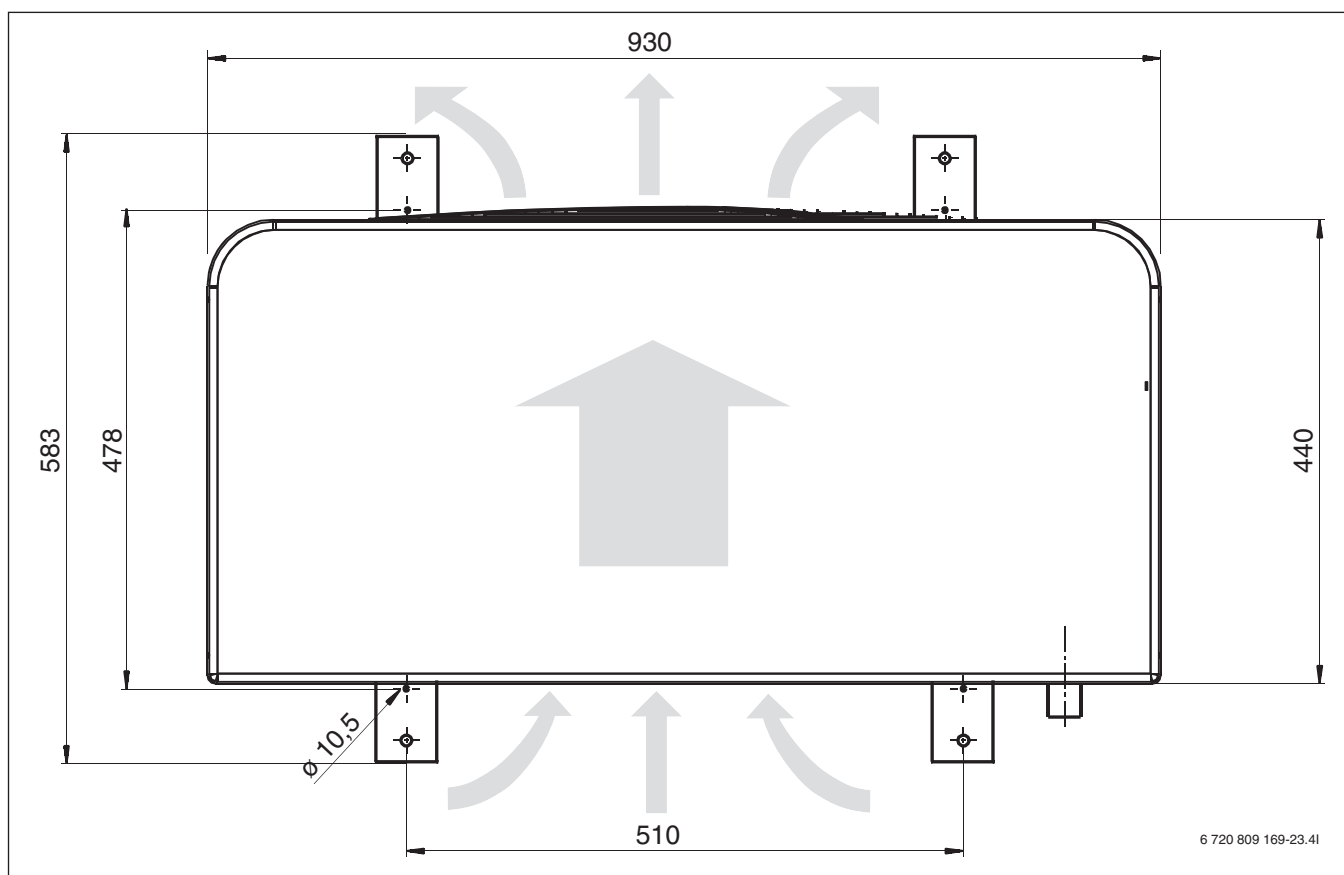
Abmessungen der SAO 60-2 / SAO 80-2, Draufsicht
